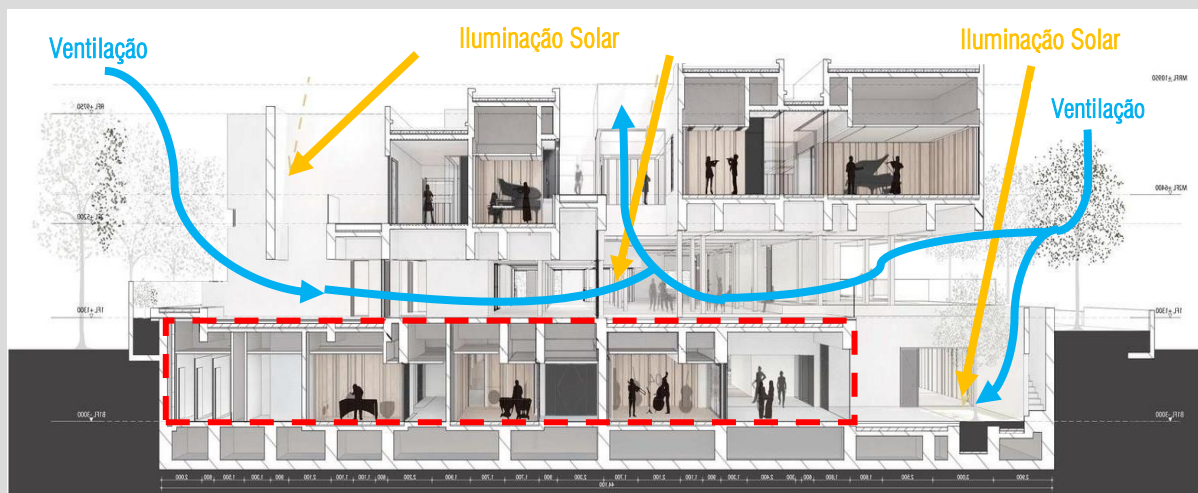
, corte do projeto. Fonte: archdaily.com.br, 2025 - modificado.
